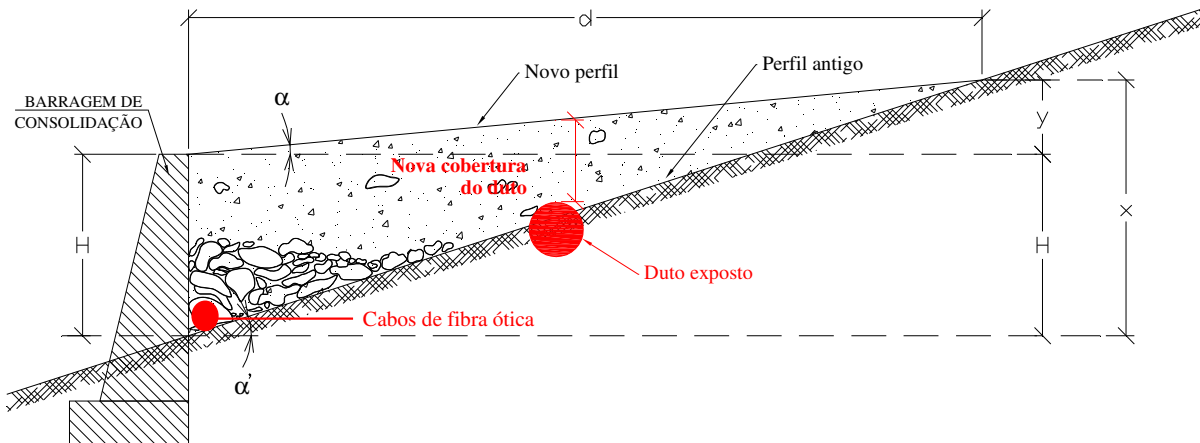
Perfil longitudinal esquemático conceitual da obra transversal.
